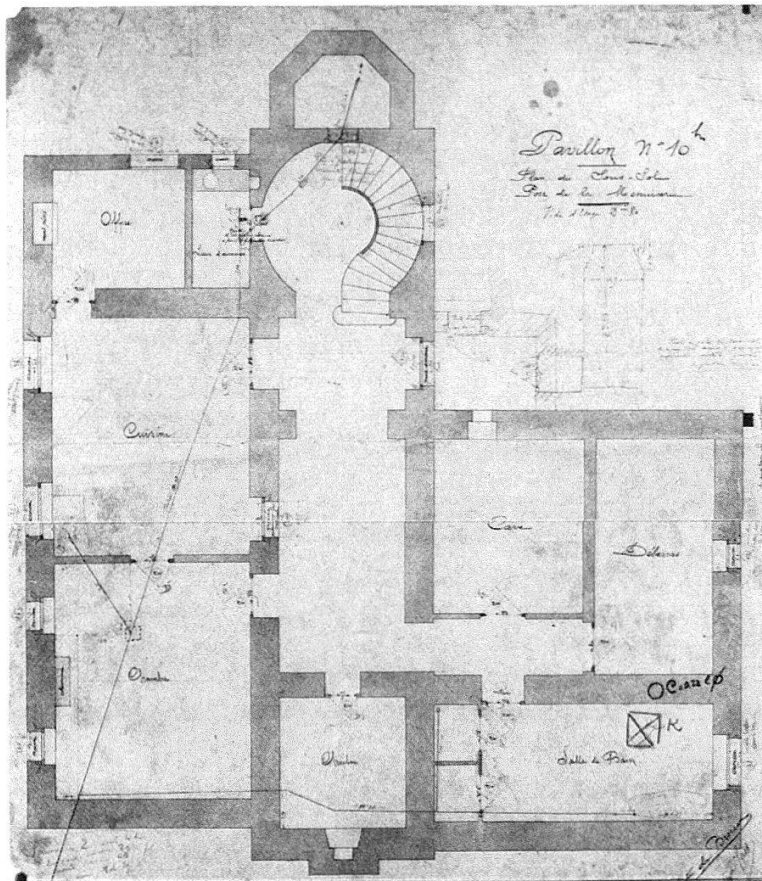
Pavillon n° 10, plan du sous-sol. Couloir central branché sur l'escalier. Cuisine et quartier domestique à l'ouest. Salle de bains à l'angle sud-est
